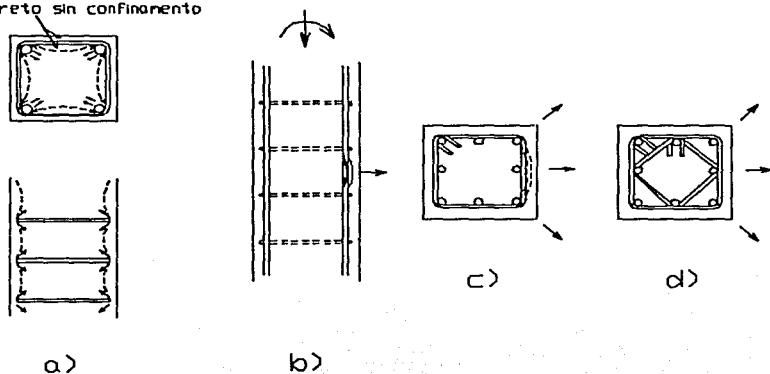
a) Confinamiento del concreto con estribos cuadrados, b) Pandeo del refuerzo longitudinal, c) Sin estribos en diamante, d) Con estribos en diamante. (1.5)
